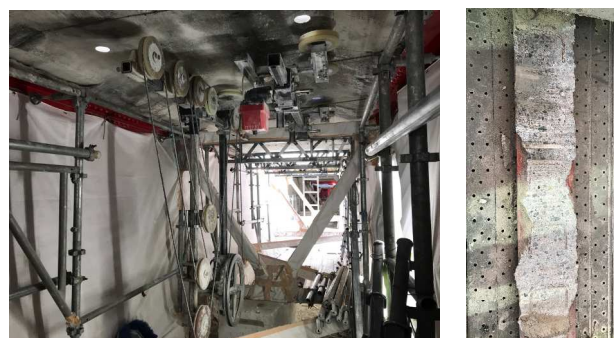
サブマリンスライサー施工状況(左)と切断面(右)
